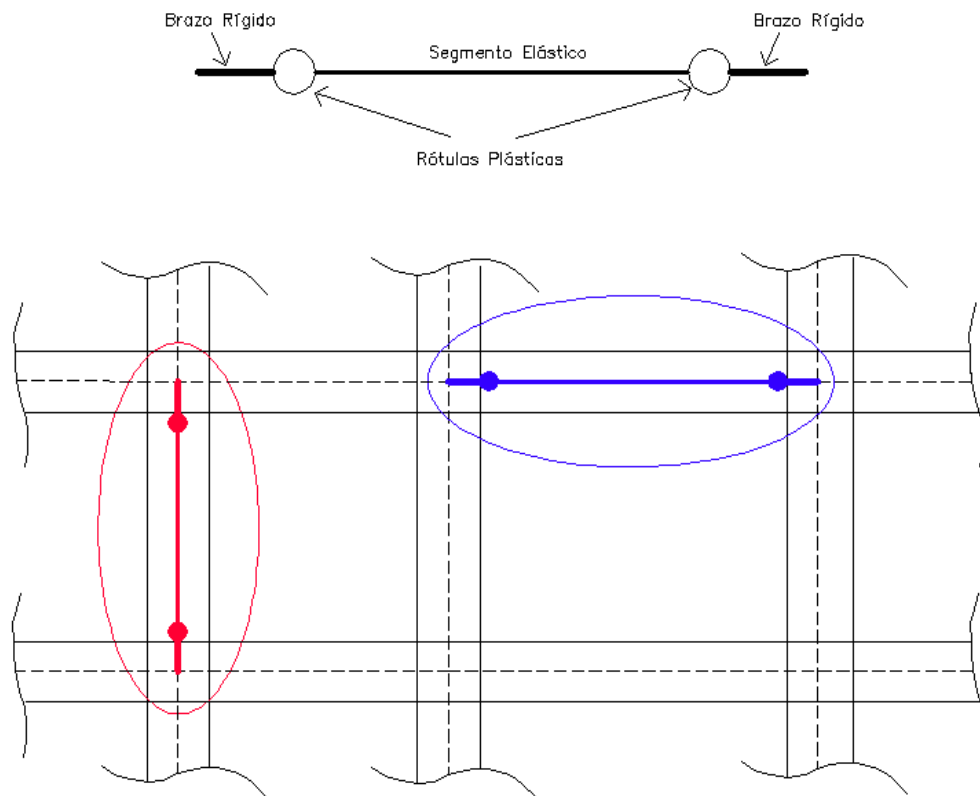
Modelación de vigas y columnas en edificios aporticados
